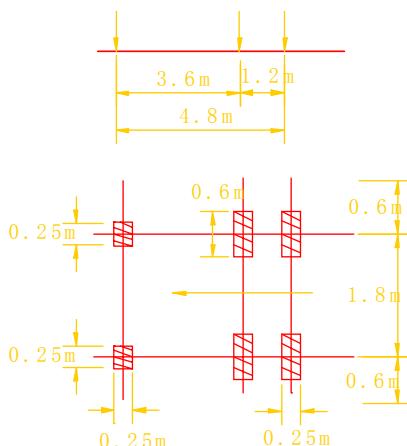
城—B 级标准车辆纵、平面布置
